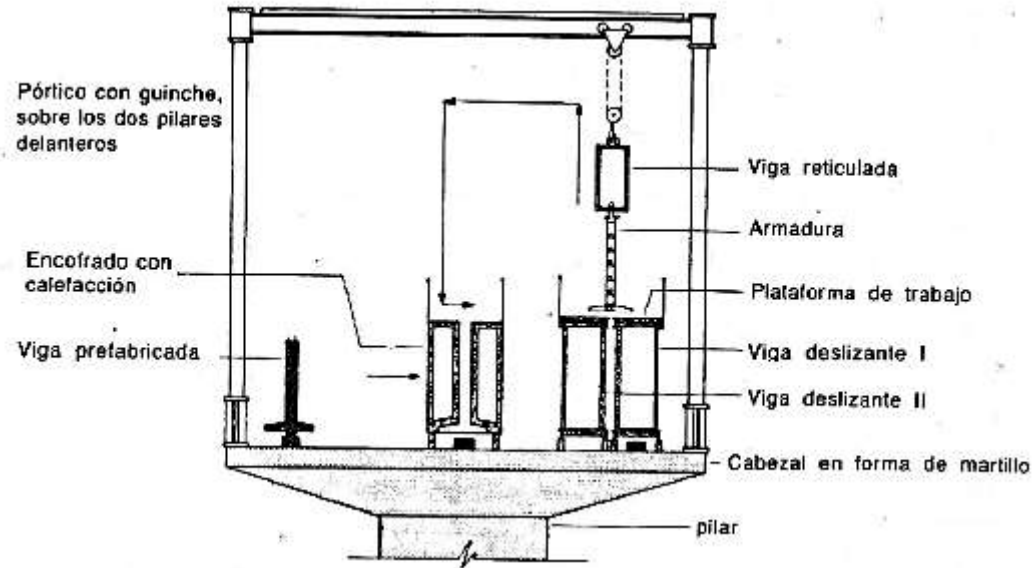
Sistema constructivo Schreck se fabrican, en el lugar definitivo, vigas longitudinales con encofrados desplazables
